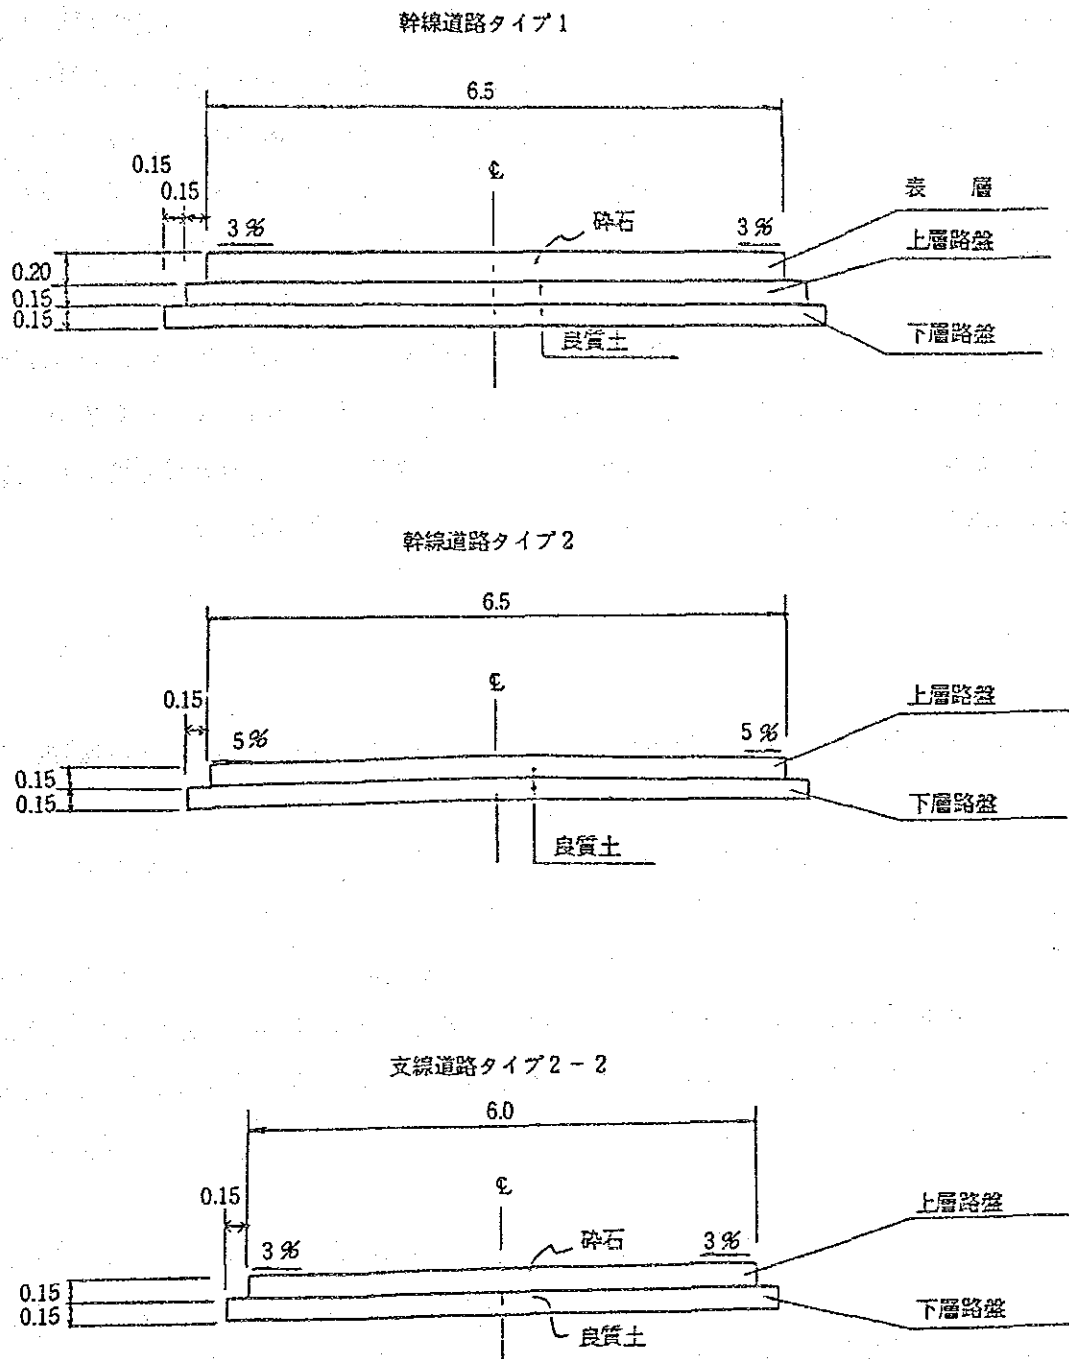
幹線及び支線道路路盤工標準断面図 (単位: m)
